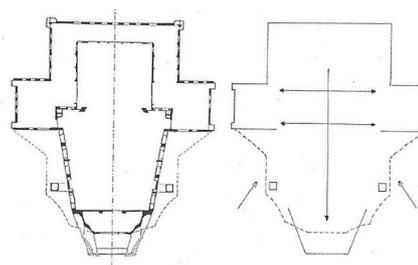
Schémas de plan d'étage. Gauche : profil spatial, droite ; profil du toit
